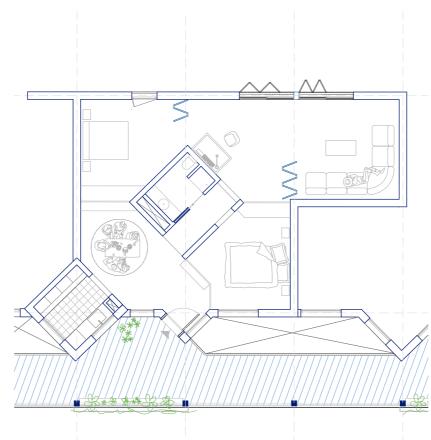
Plano de planta del modelo de vivienda 5H. Elaboración propia
